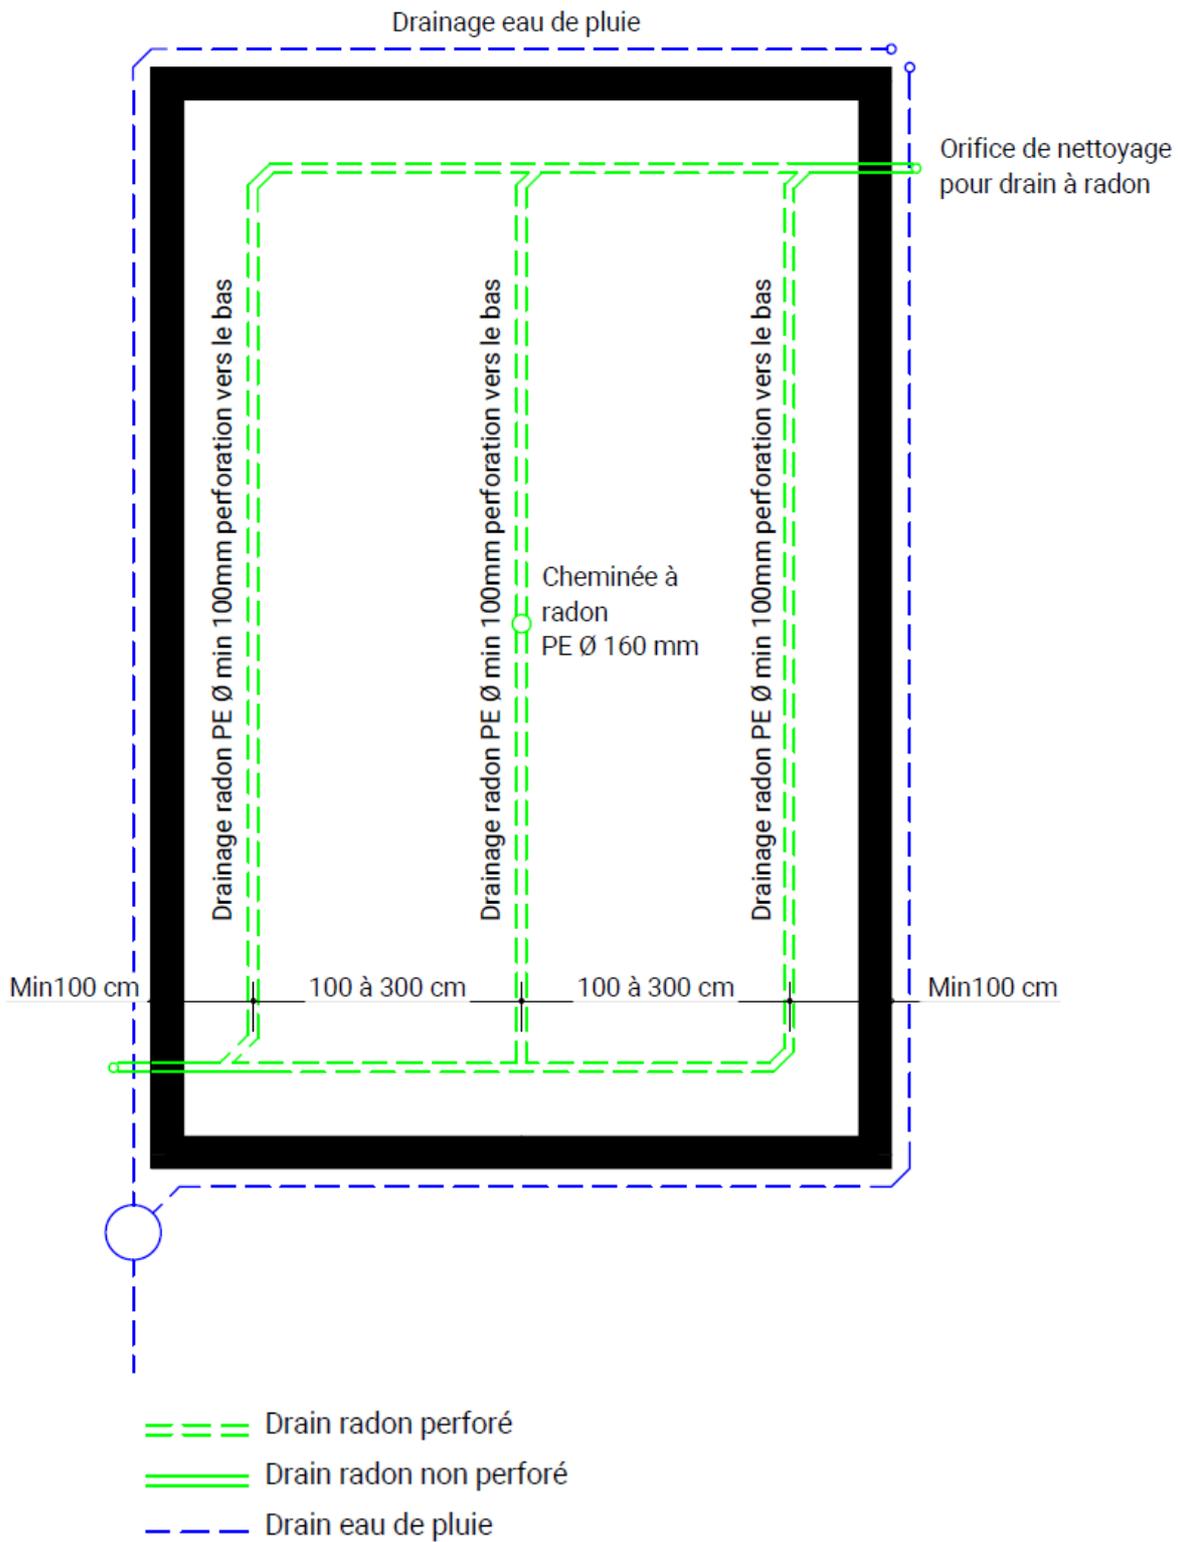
Vue en plan d'un drainage sous radier prêt à être raccordé à un ventilateur (détail : croqAIR, HEIA-FR)
